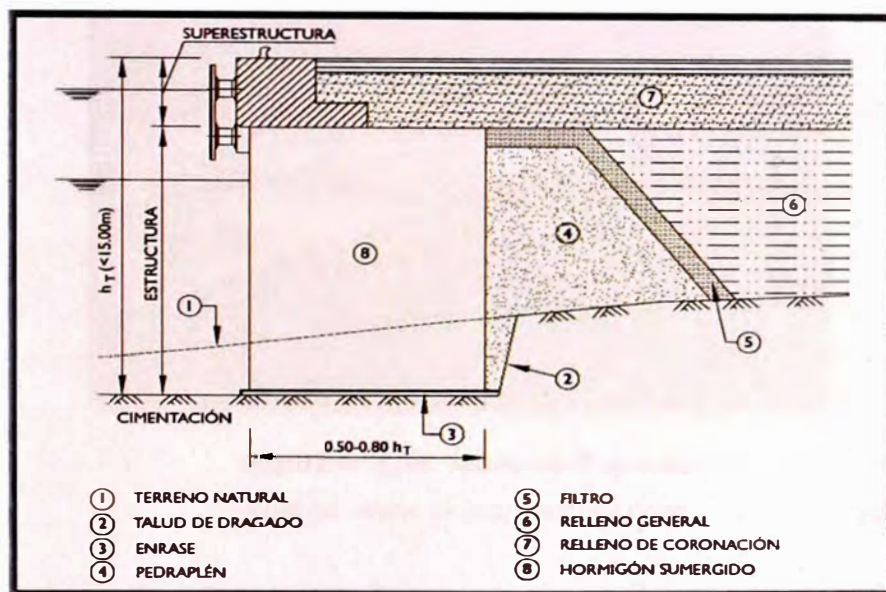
Sección Tipo Muro de Concreto Sumergido
